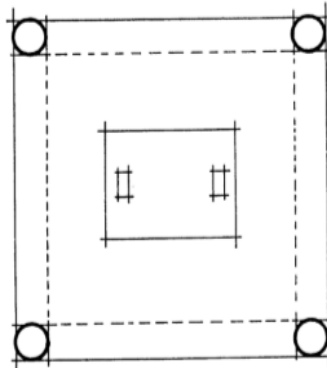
مسقط أفقي لقبة أبو تراب بالعباسية .
